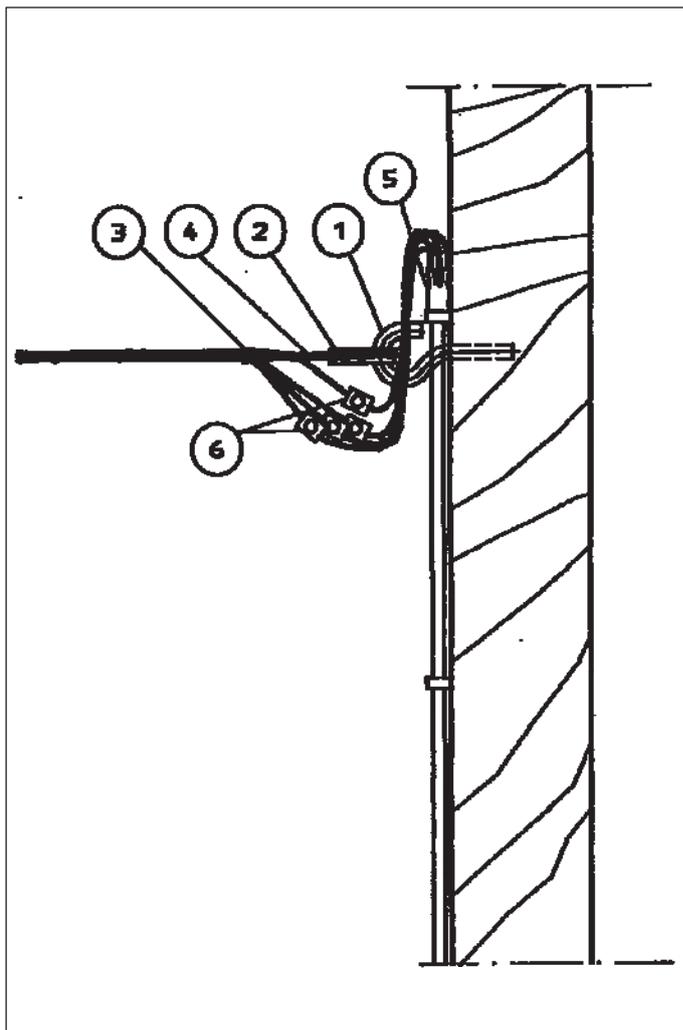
Крепление провода к стене здания с помощью крюка.
